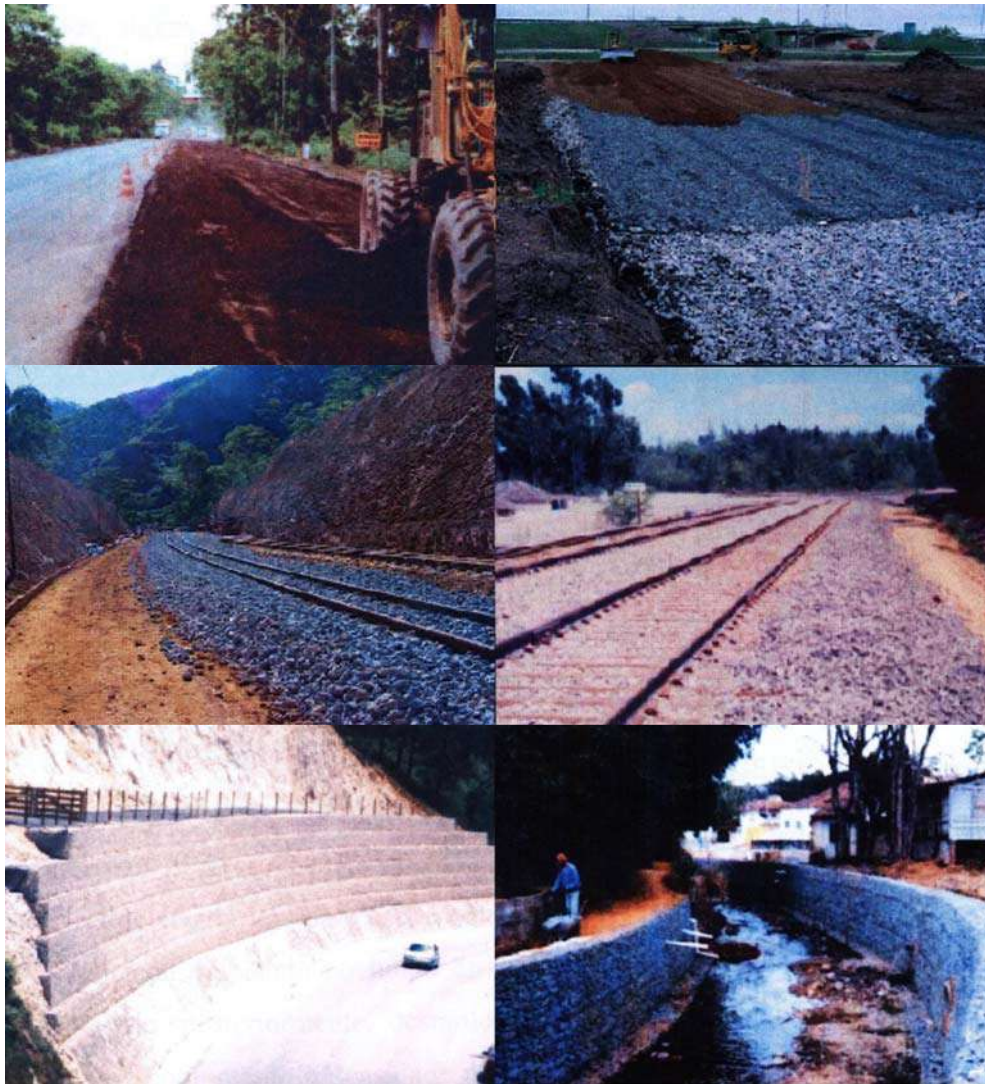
Aplicações para escória de aciaria, pavimentação, lastro ferroviário e contenção de encostas (PENA, 2004).
